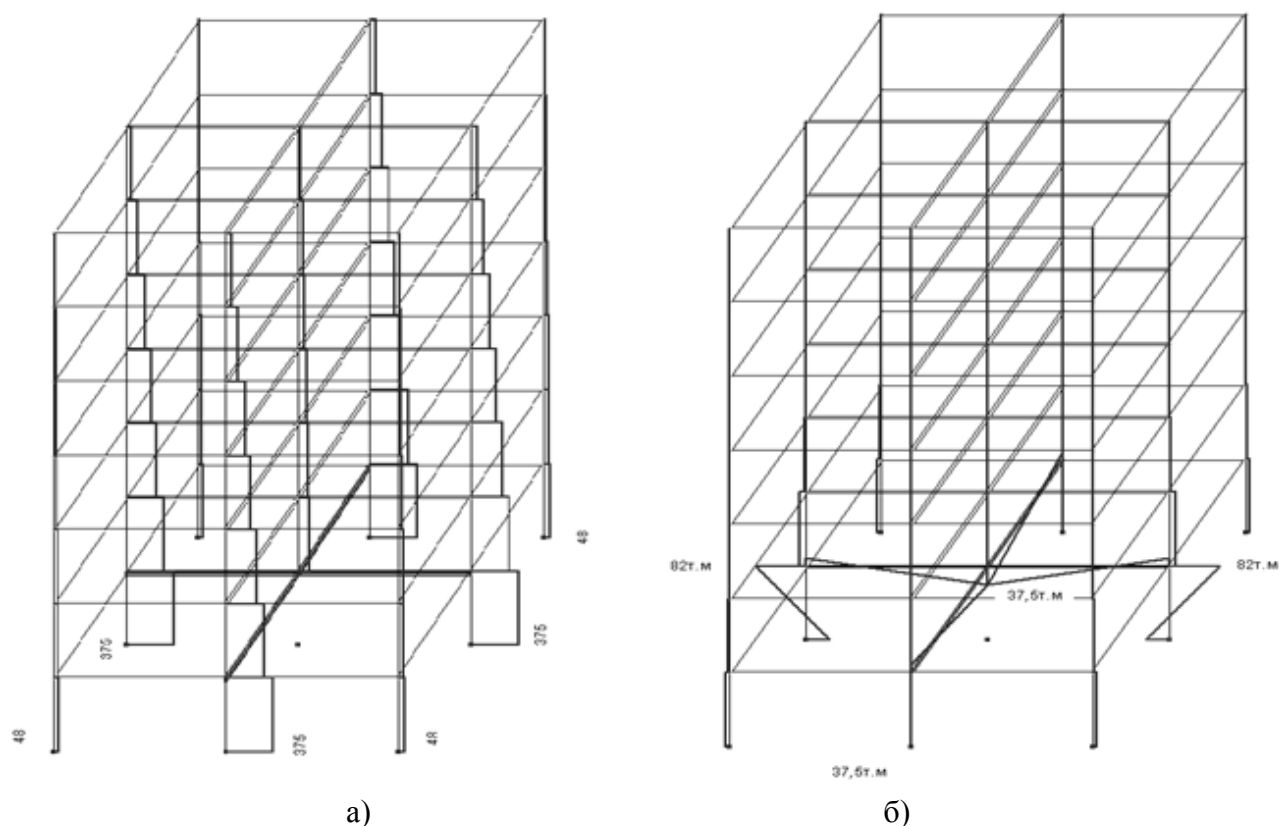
Осевые усилия в стойках и моменты в перекрытии пространственной 7-и этажной рамы после удаления промежуточной колонны: а–осевые усилия, б–моменты в перекрытии над удалённой стойкой.
